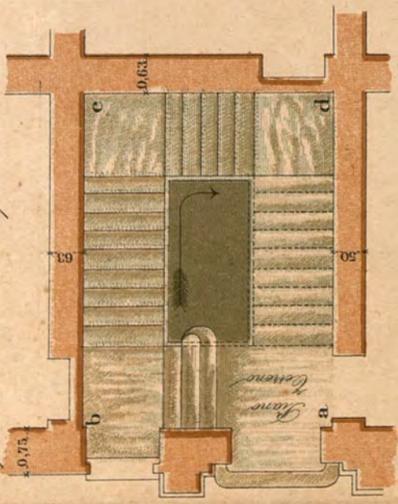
La pianta della scala dall'ammazzato al primo piano.
